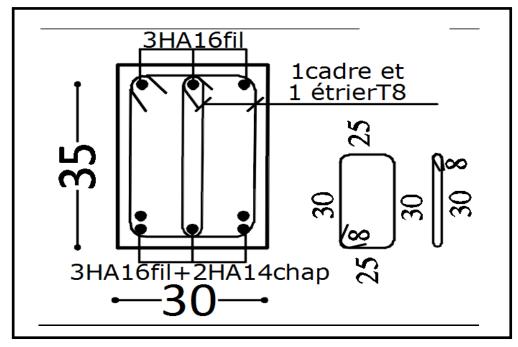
Ferraillage en travée d'une poutre principale.
